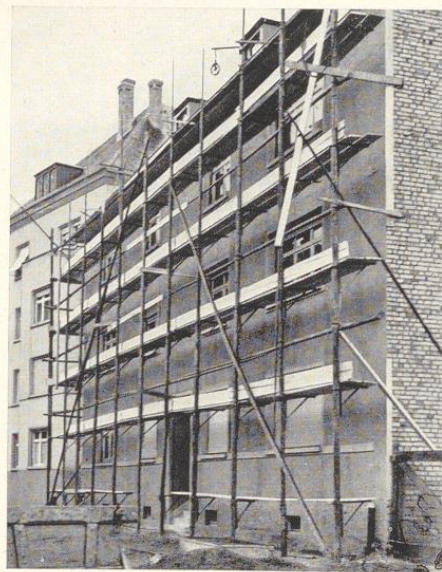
Badisches Konsolgerüst mit einer Gerüststange und eisernen Konsolträgern
